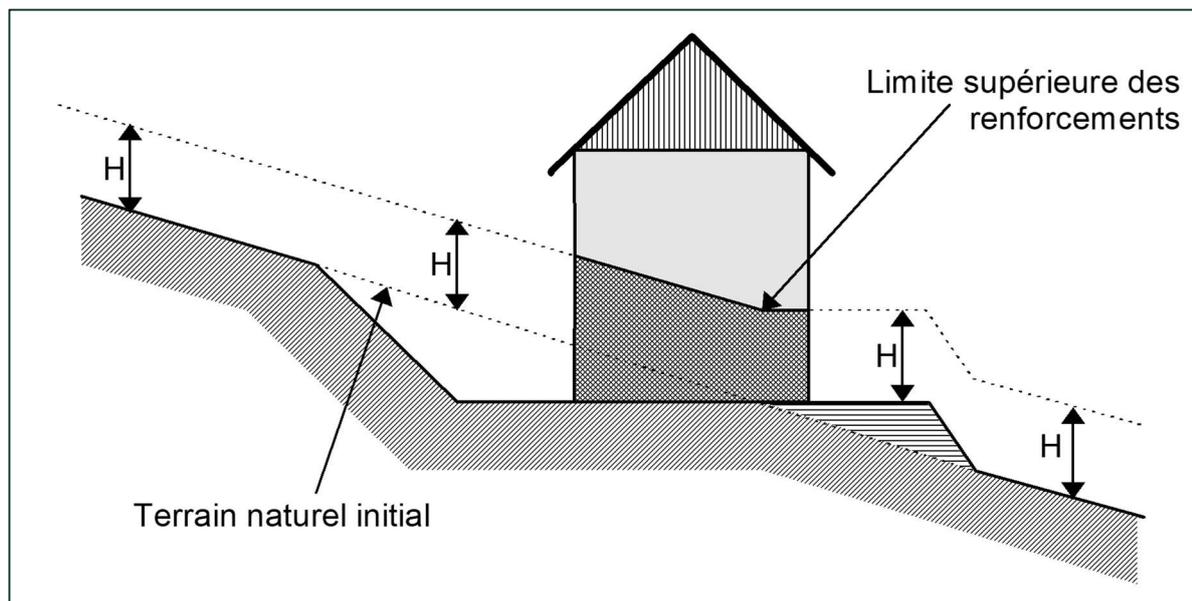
Définition de la hauteur de renforcement pour une construction en pente
